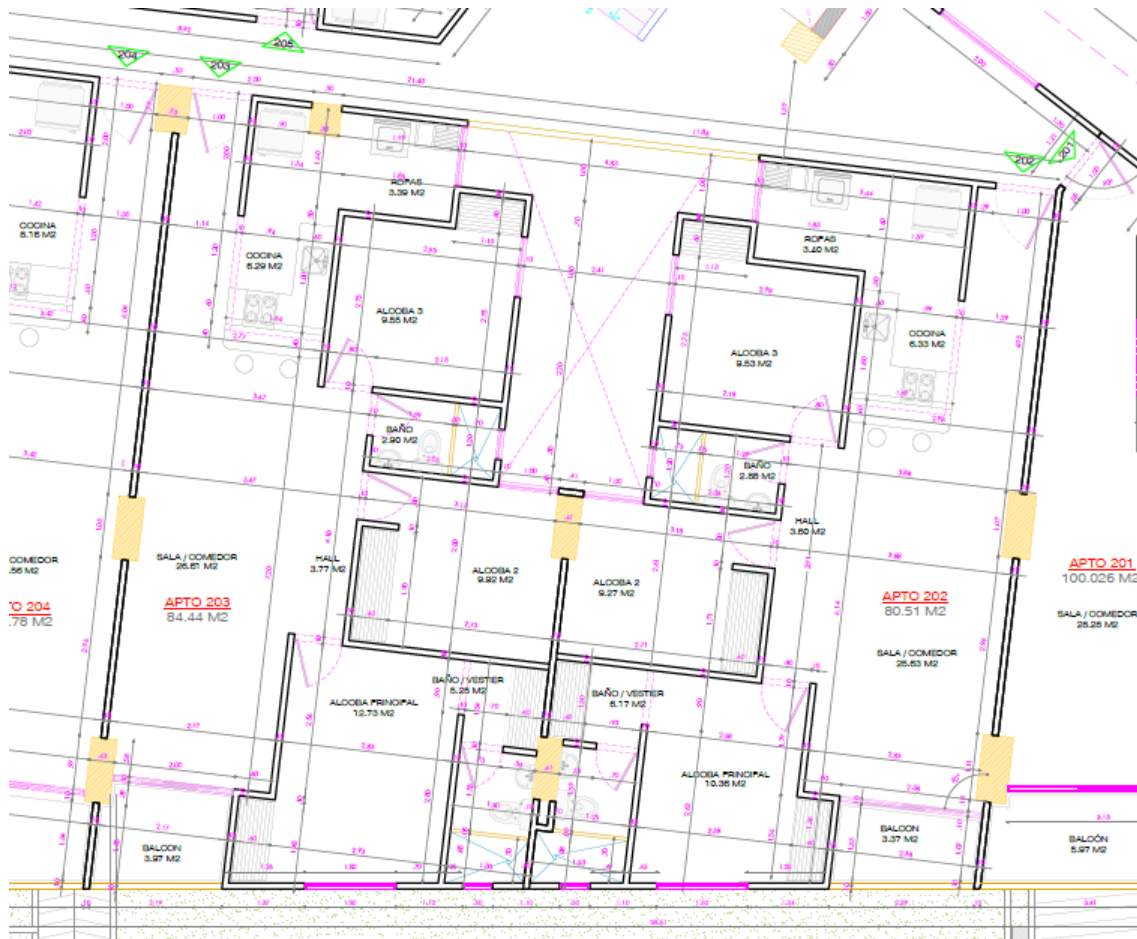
Planta Arquitectónica apartamentos tipo 2 y 3 (Pedrozo Perez)
